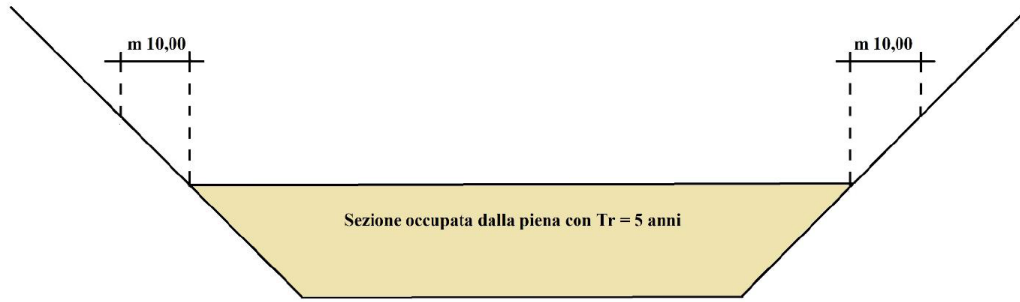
Particolare sezione idraulica - DSG 119/2022
